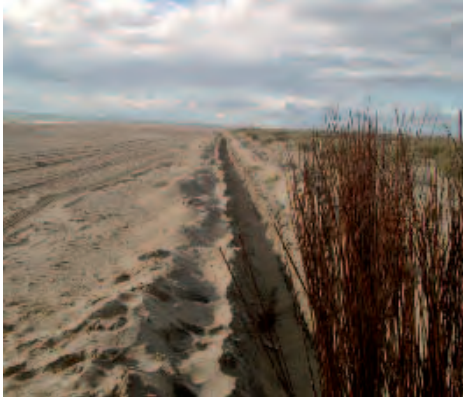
Installation des brise-vent en osier. Creusement d'un fossé et mise en place. © Carlos Ley
